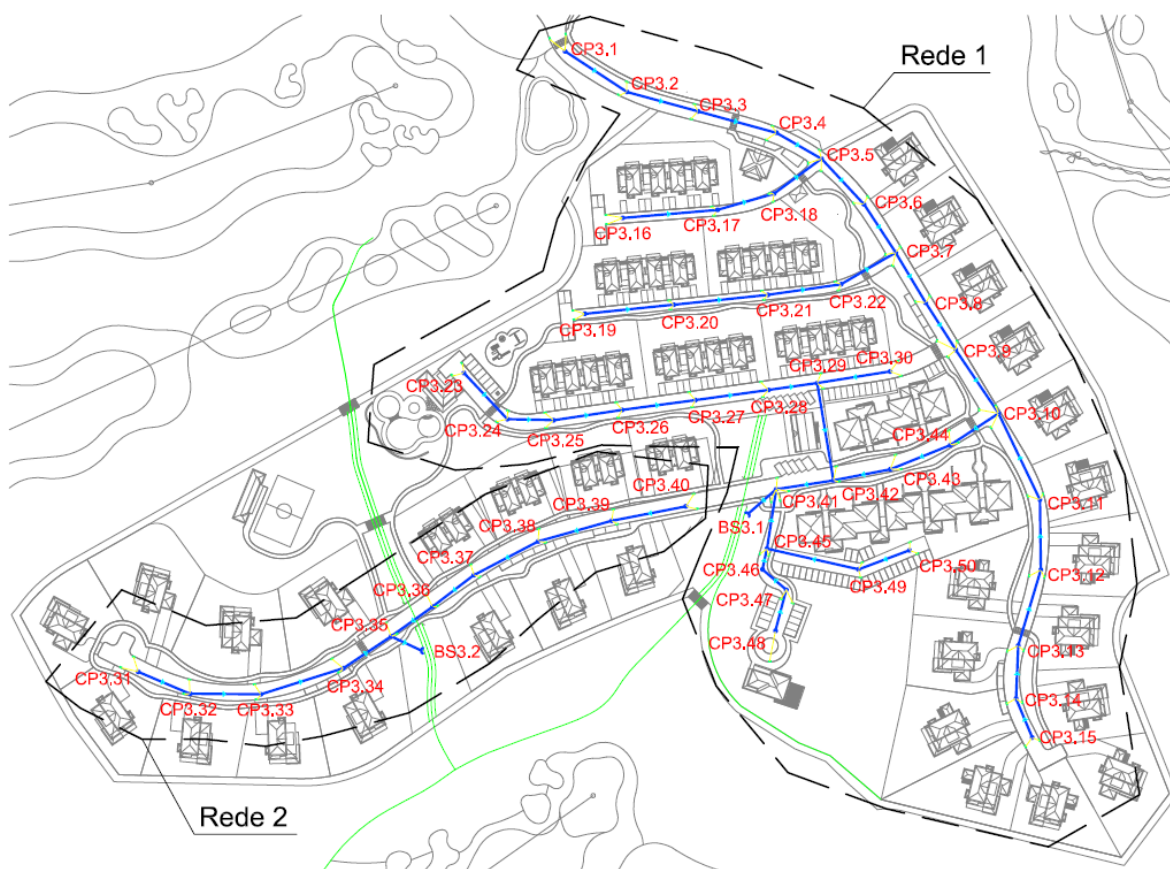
Traçado das redes de drenagem de águas pluviais (aldeamento 3).
